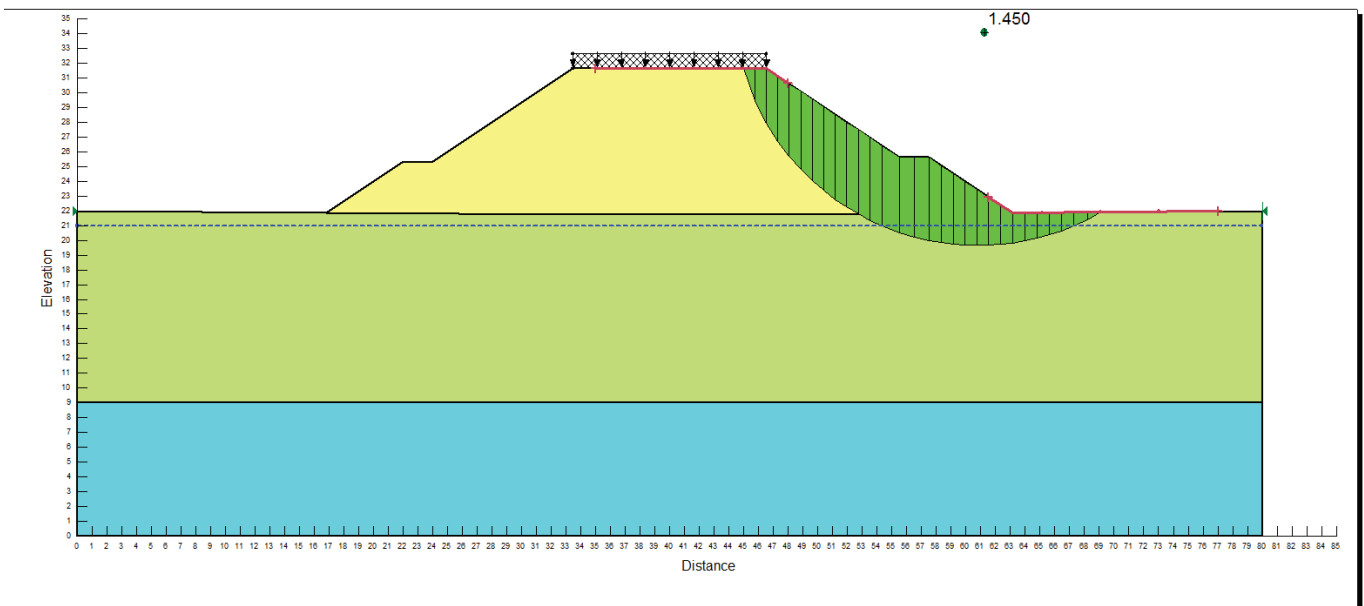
Sezione A1-34 – pk 0+480 – Analisi di stabilità in condizioni statiche
